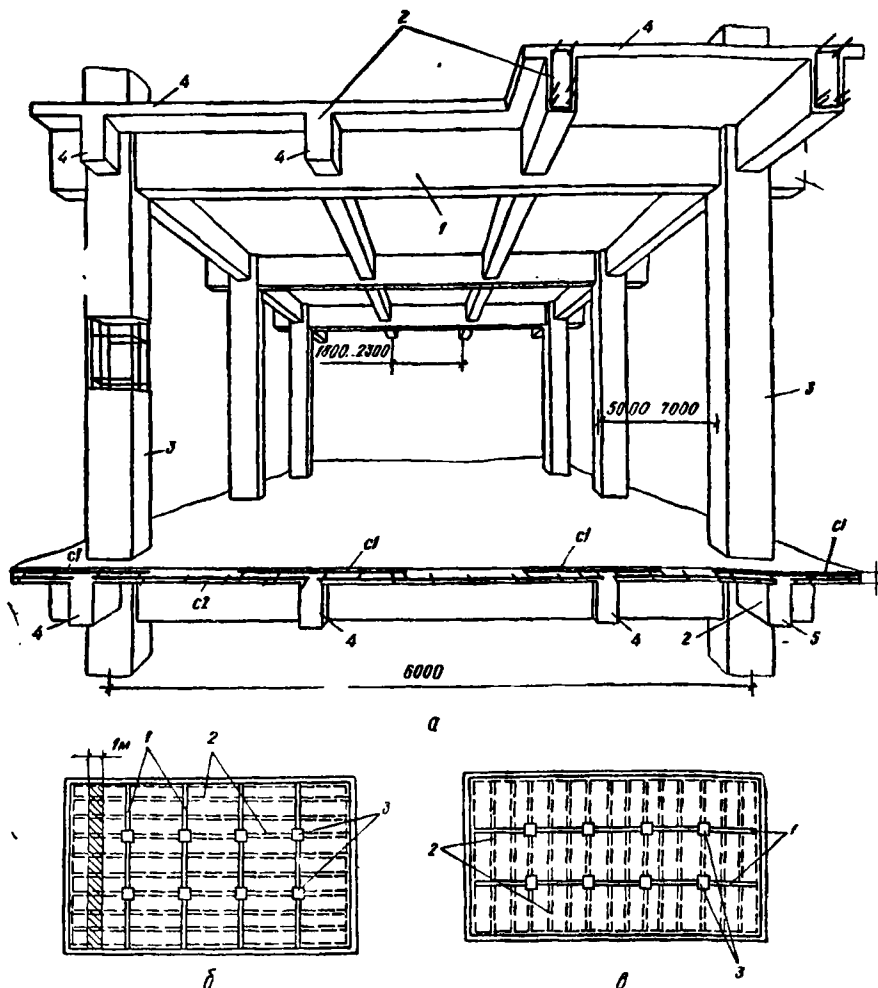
Монолітне ребристе перекриття з балковними плитами:
